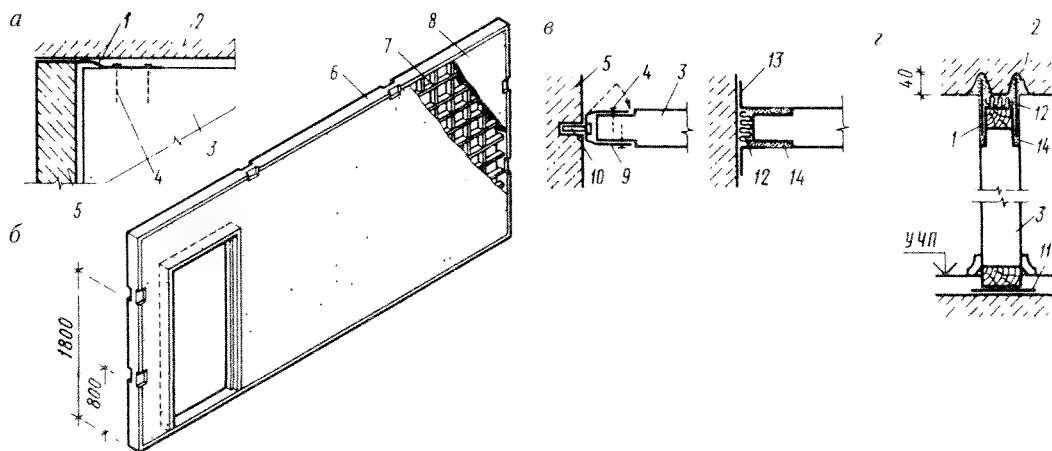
Крупнопанельные гипсобетонные перегородки:
